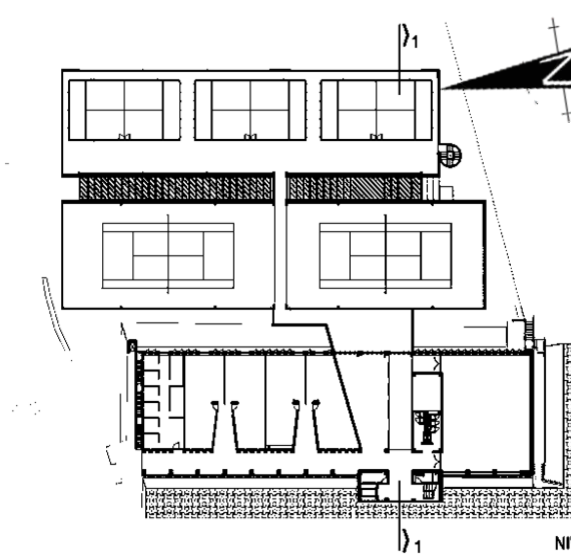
Planta Arquitectónica, nivel 1
